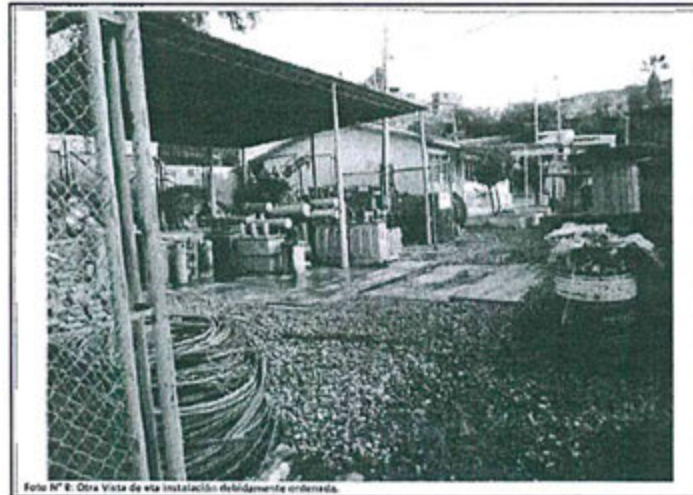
Otra Vista de esta instalación debidamente ordenada.
